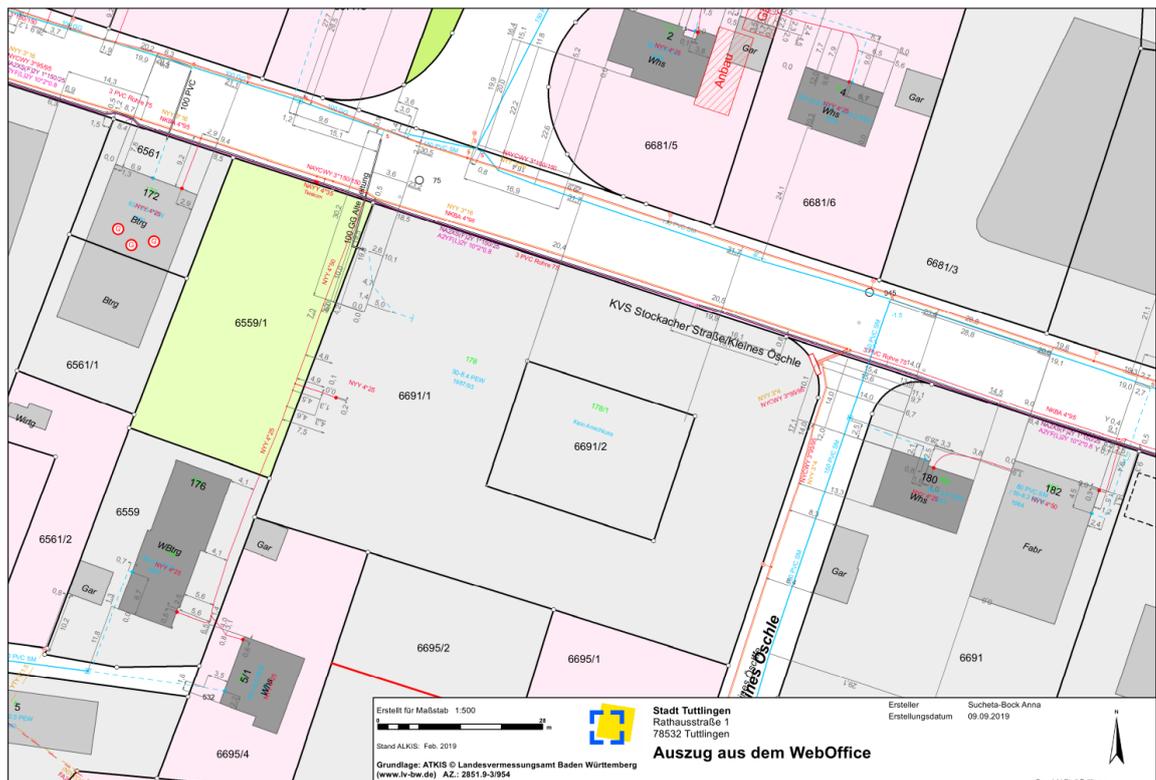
Auszug Leitungsbestand, Stadt Tuttlingen, Stand 09.09.2019
